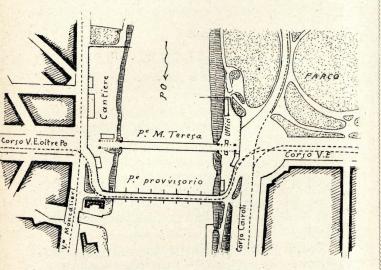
Schizzo planimetrico. — Scala di 1:5000.
